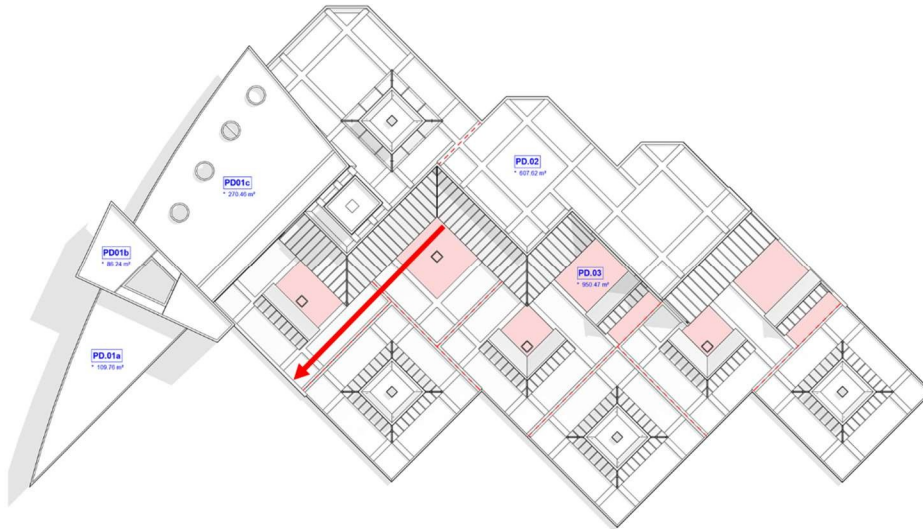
Drainage de la nouvelle surface du toit (schéma)
